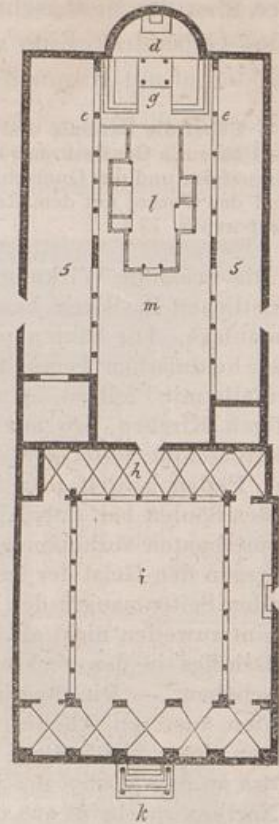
Grundriss von S. Clemente in Rom (nach d'Agincourt).
